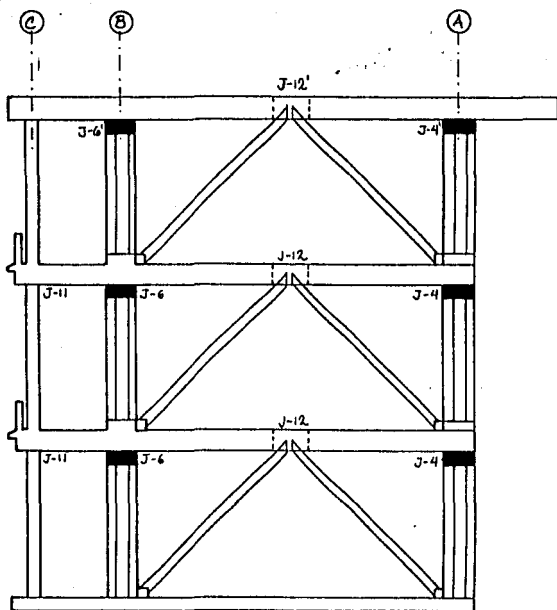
PLANTA LOCALIZACIÓN DE CONTRAVIENTOS
